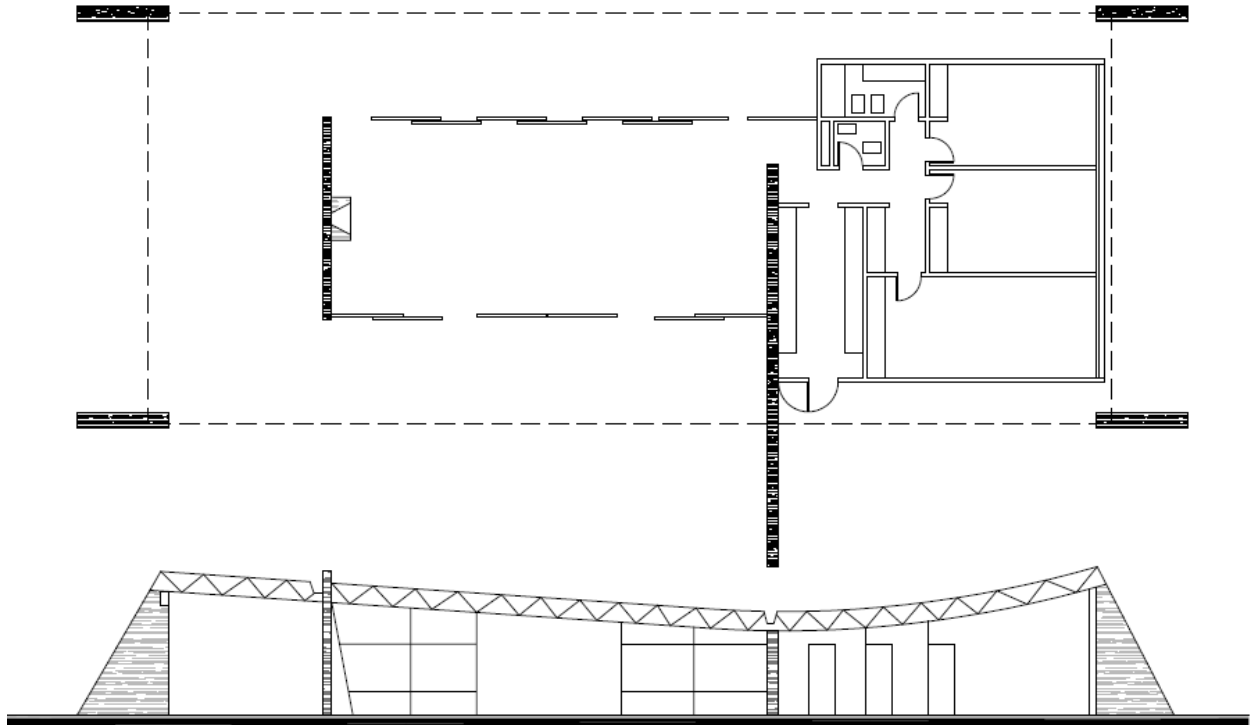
| Residência Edmundo Cavanelas. Planta Baixa e Corte
